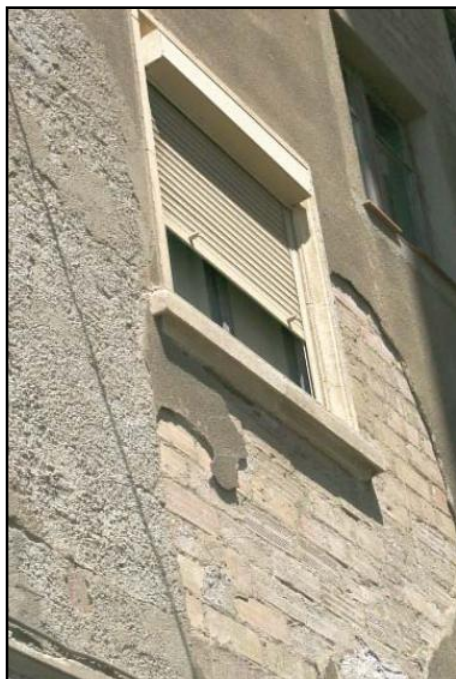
Aplanado de protección desprendido debido a calidad deficiente en su colocación
